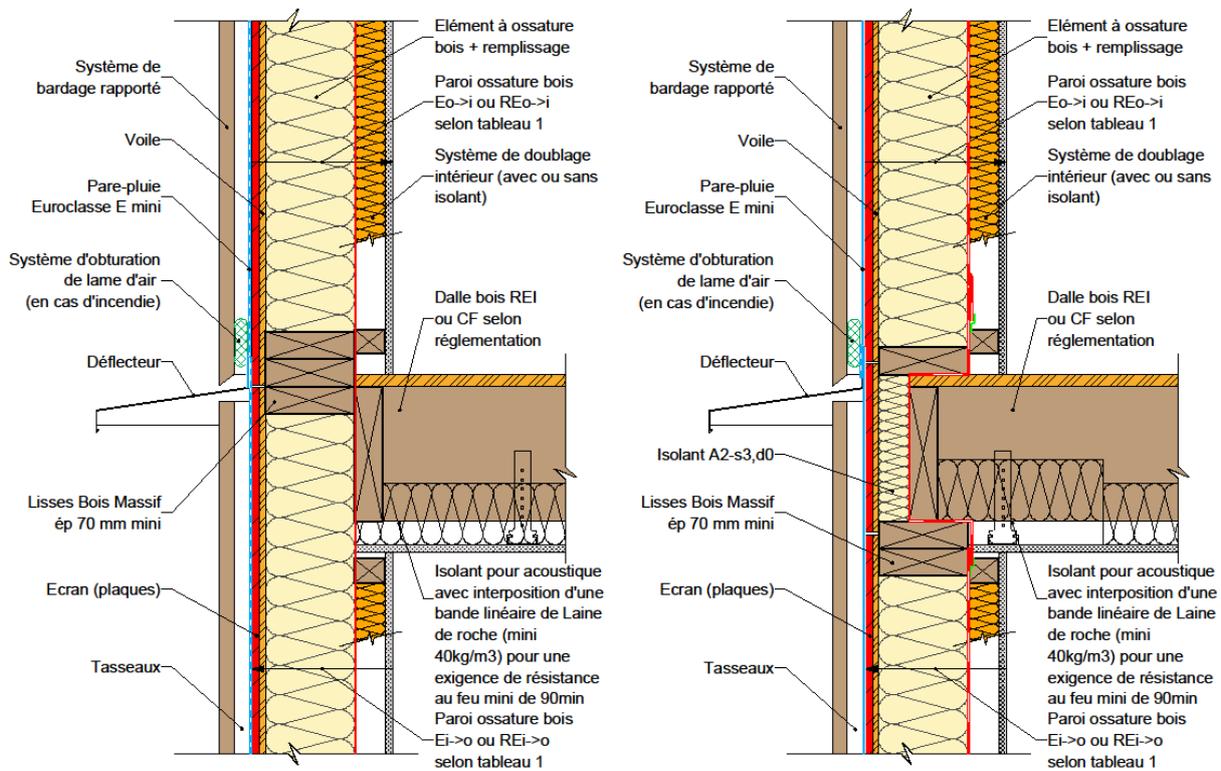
Façade/mur ossature bois & plancher en ossature bois.
